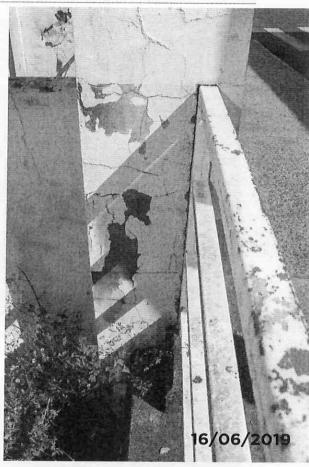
Detalhe de vegetação e fissura na parede de apoio do guarda corpo. E é visível também forte ponto de corrosão.
